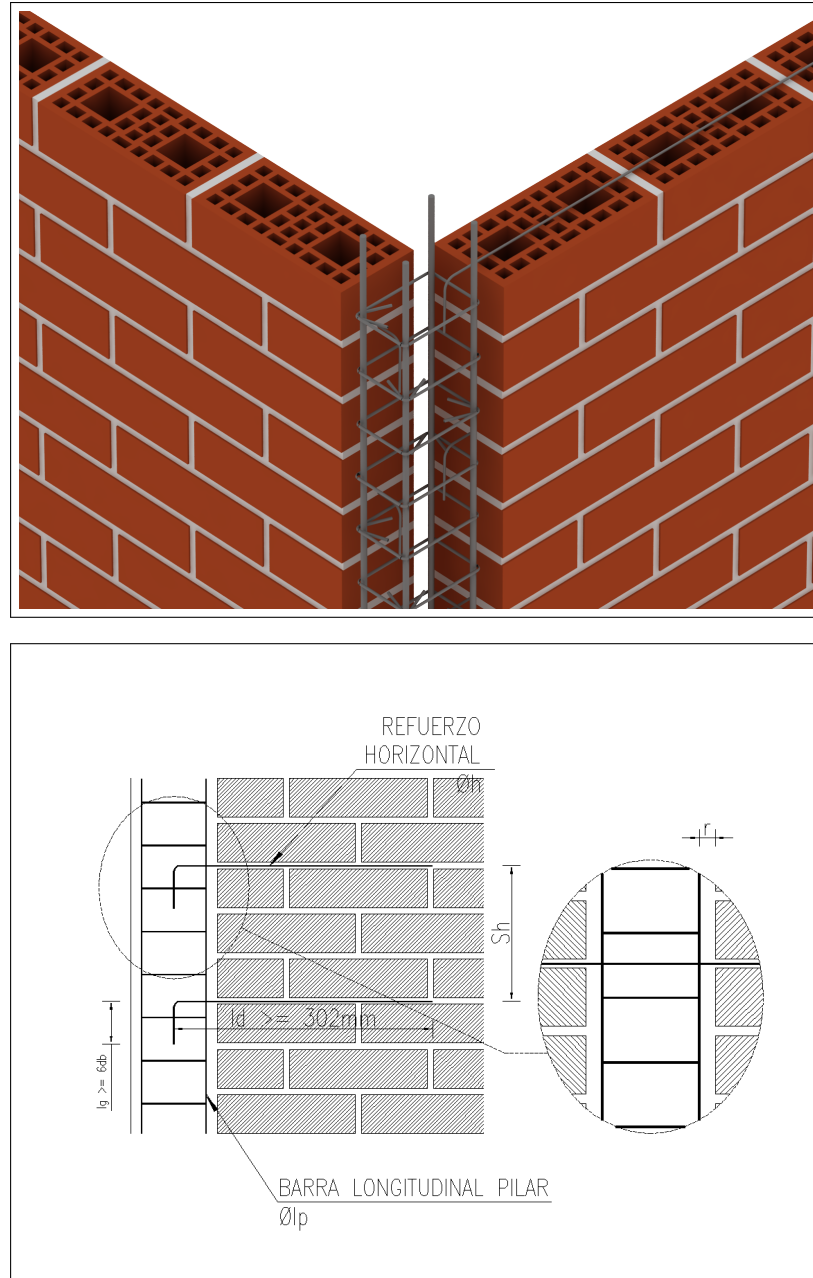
Detalle de la unión con conectores entre el paño de albañilería y un pilar de confinamiento en el encuentro de muros.
